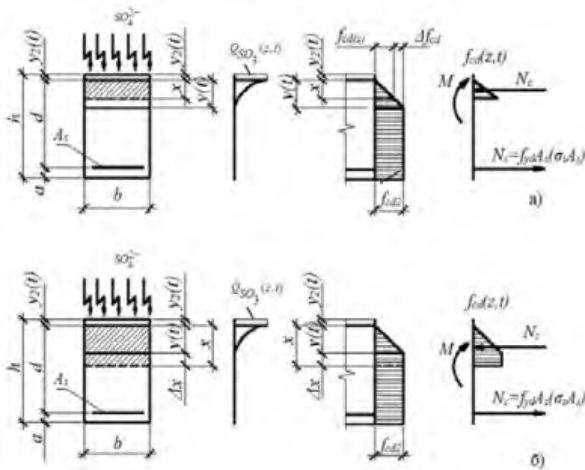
Стадія III. Розрахункова схема елемента / Stage III. Calculation scheme of the cross section of the element:
